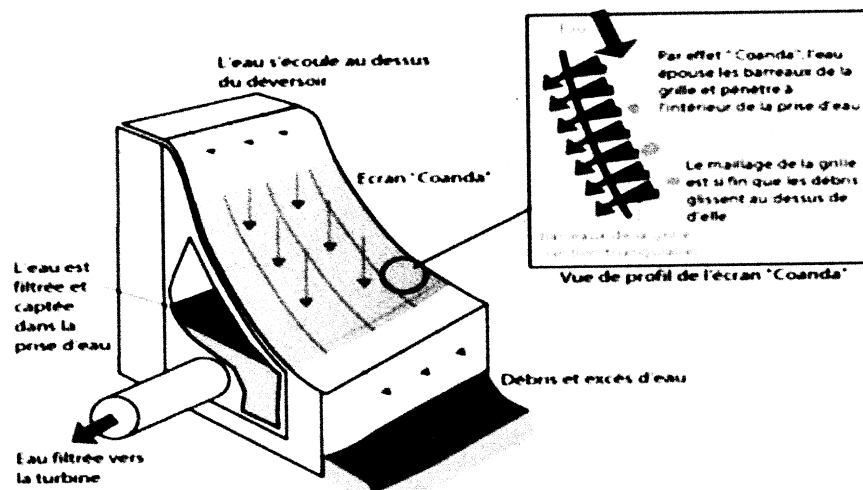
Schéma de principe d'une prise d'eau par en-dessous avec grilles Coanda
